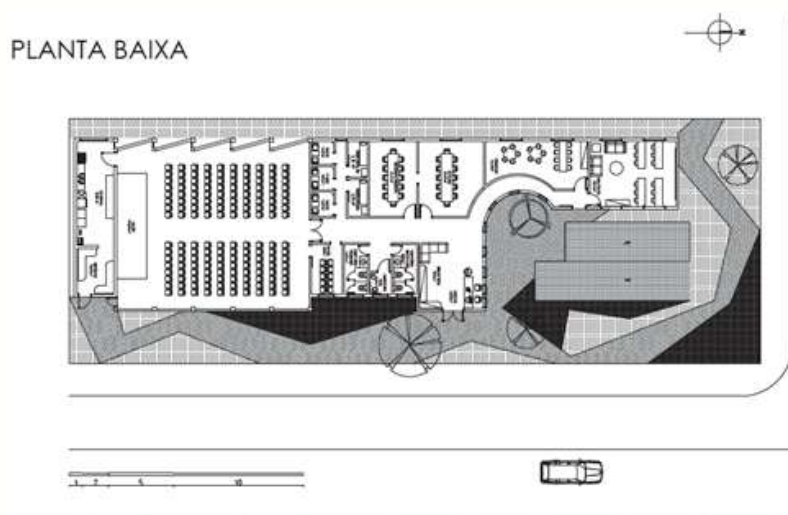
Planta baixa da edificação. Fonte: Acervo do EMAU Perspectiva
